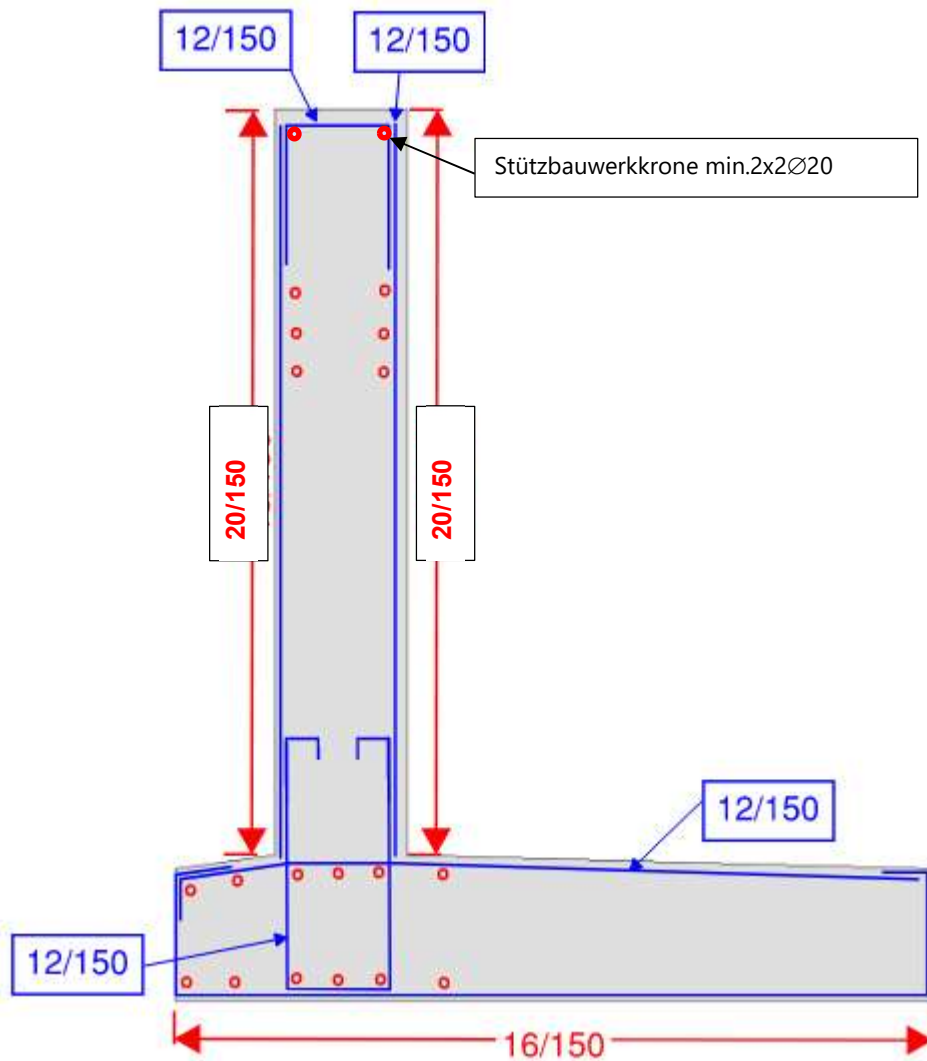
Bewehrungsskizze des Stützbauwerks
